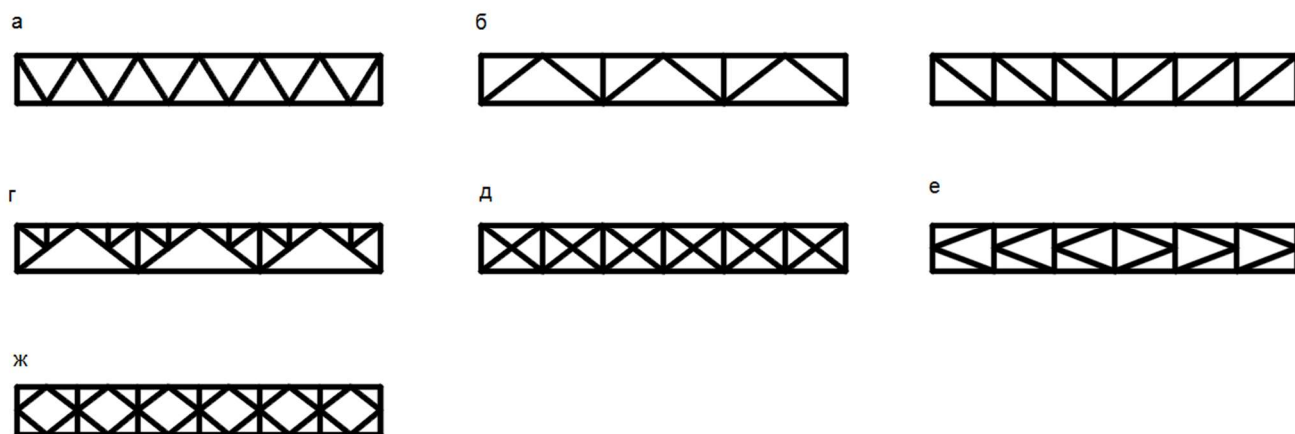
Типы решёток ферм: а- треугольная; б- треугольная со стойками; в- раскосная; г- шпренгельная; д- крестообразная; е- полураскосная; ж- ромбическая.
